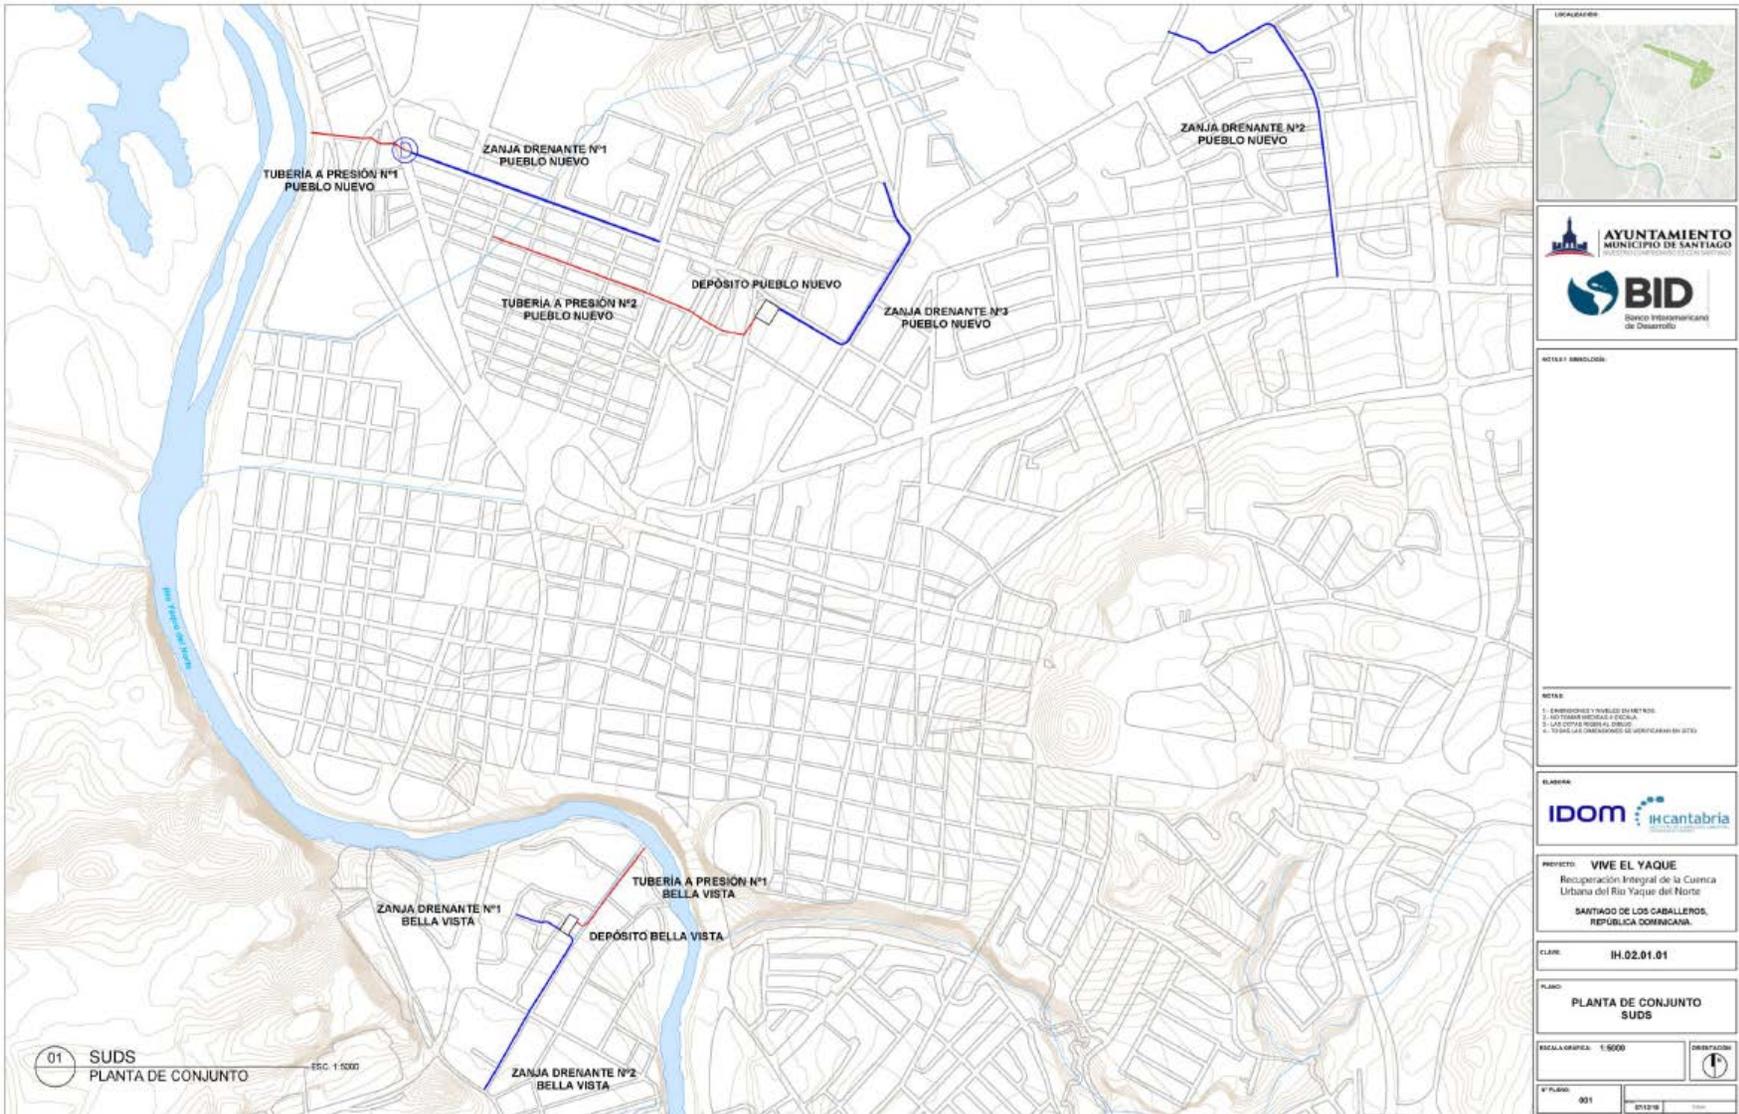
Planta de conjunto de los sistemas urbanos de drenajes sostenibles de Santiago (IDOM, 2018)
